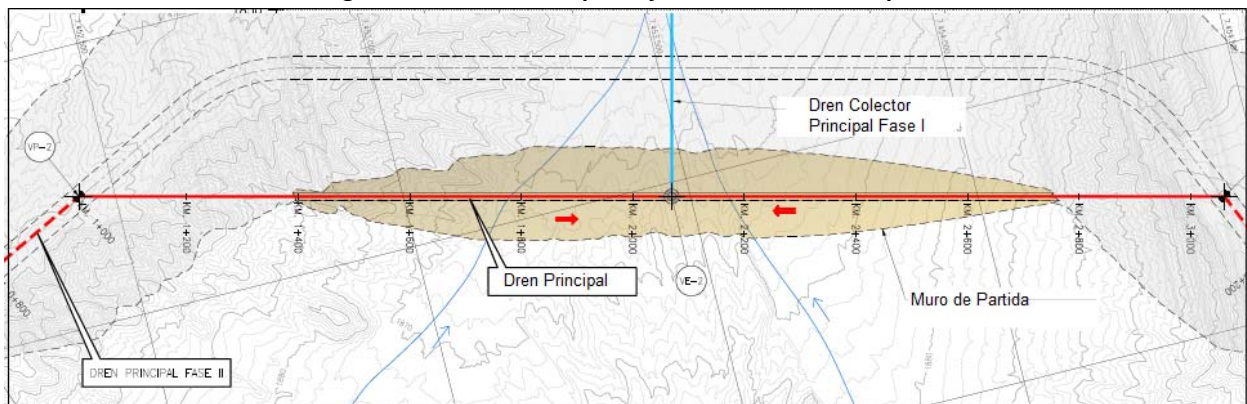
Planta General Sistema de Drenaje Muro DRE-DMC
